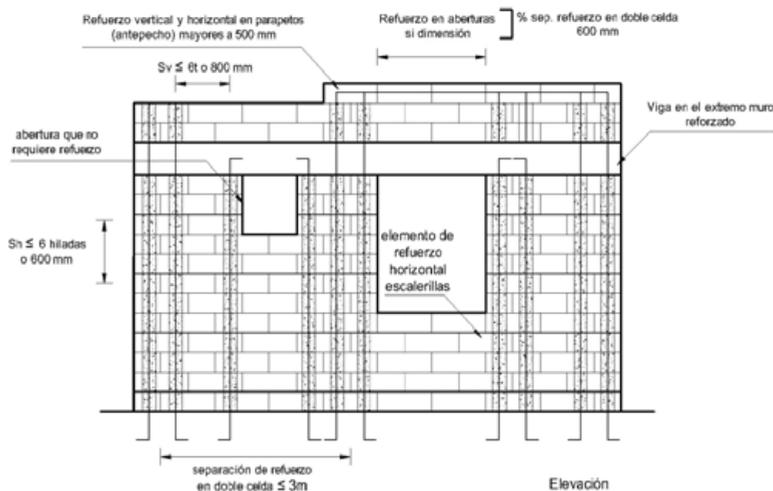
Detalle del reforzamiento vertical, detalle de reforzamiento en aberturas
